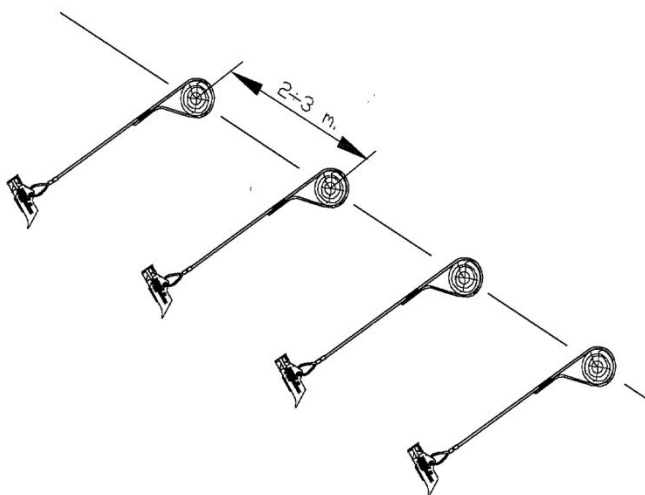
Rappresentazione di un sistema di ancoraggio.
